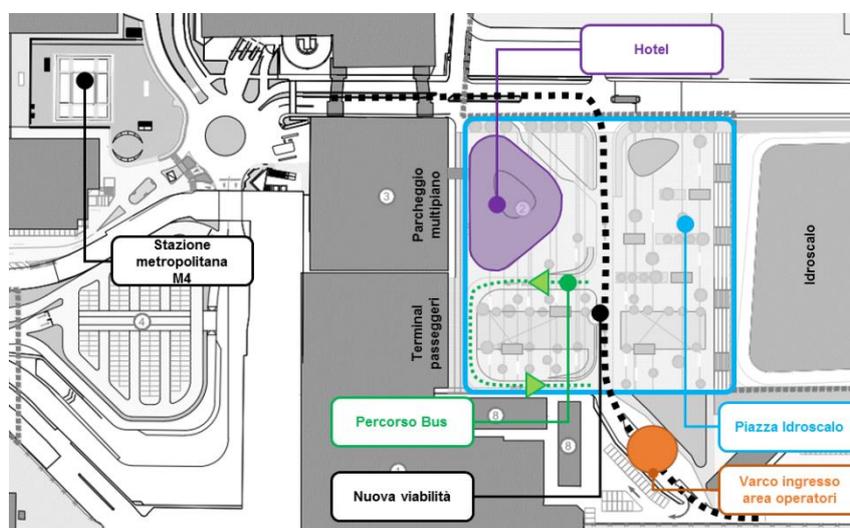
Strutture landside est: hotel e piazza idroscalo, configurazione prevista dal Masterplan
